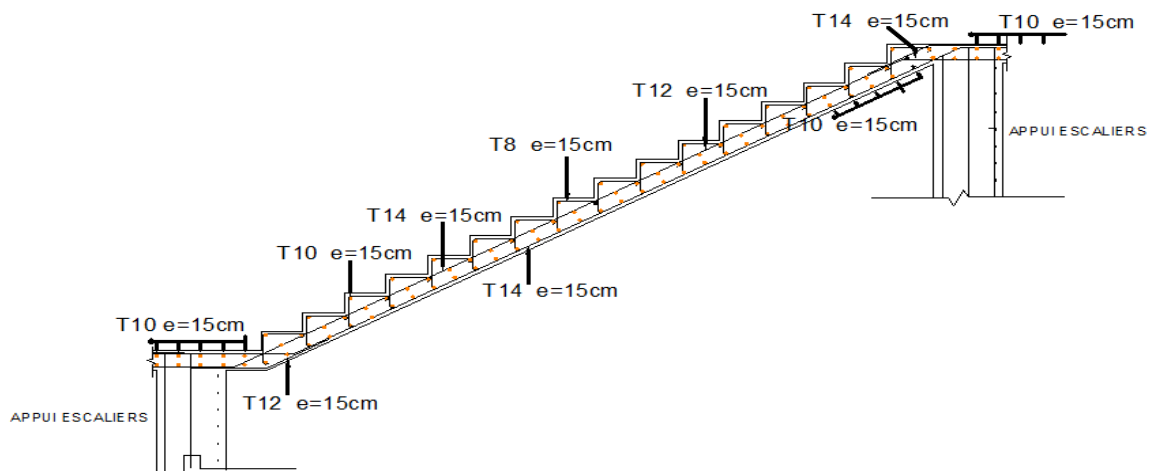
Coupe ferrailage escaliers intermédiaire
